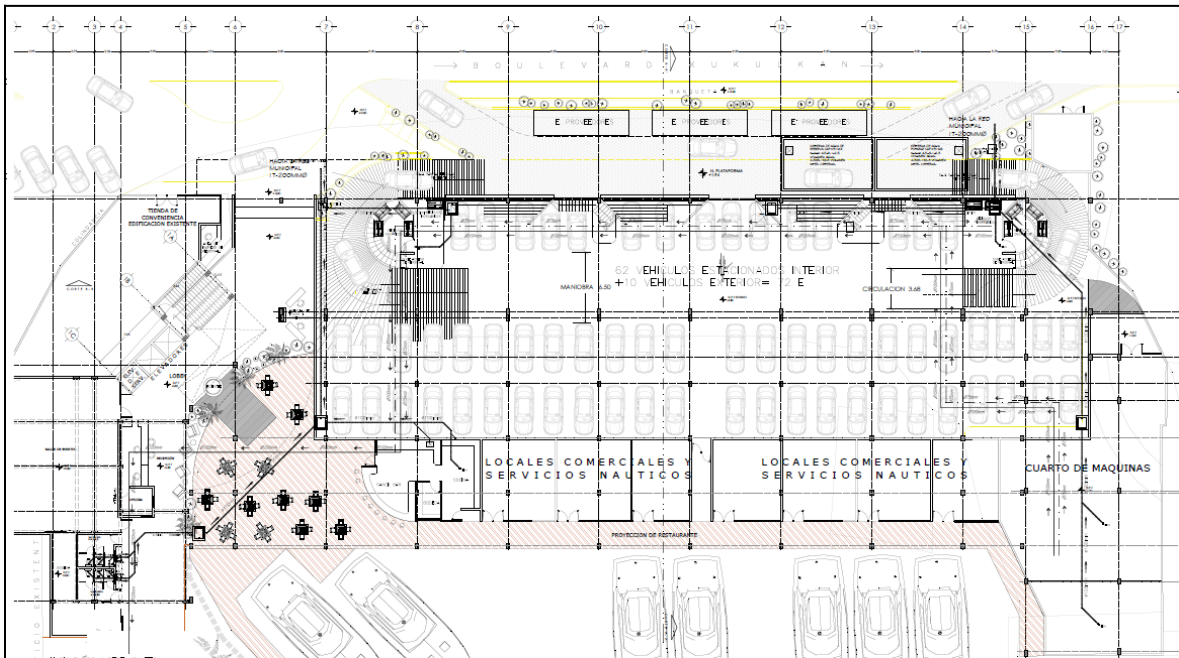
Plano de la representación de la red hidráulica, sanitaria, pluvial hacia las conexiones.
